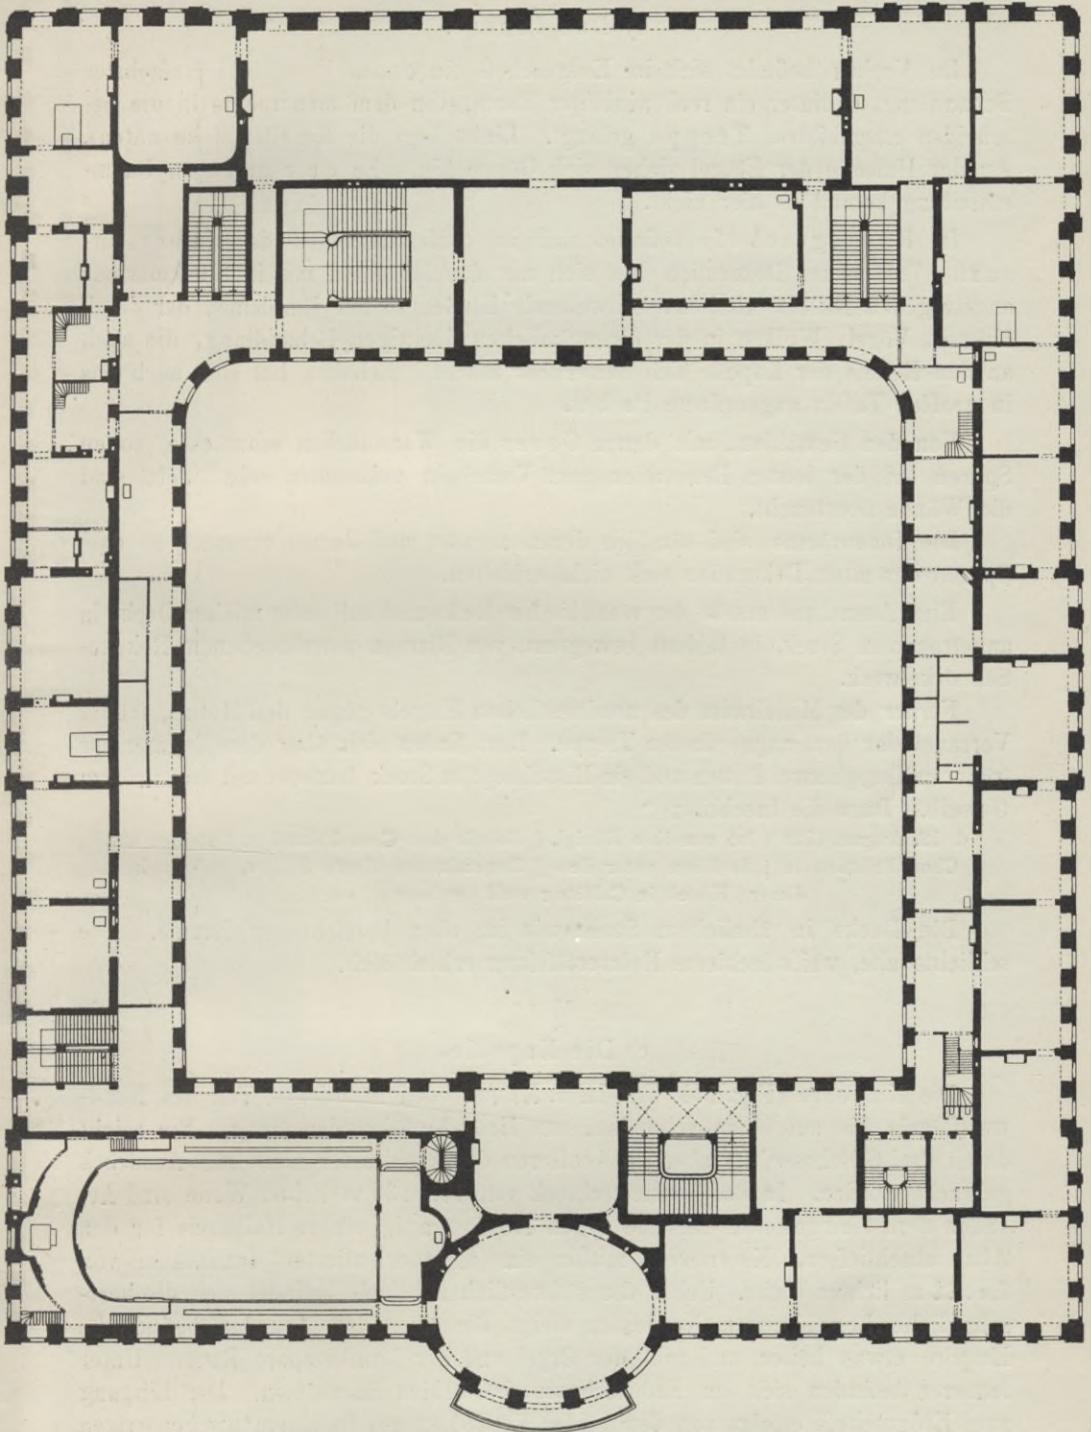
Hubertusburg, Schloß, Grundriß des ersten Obergeschosses.
